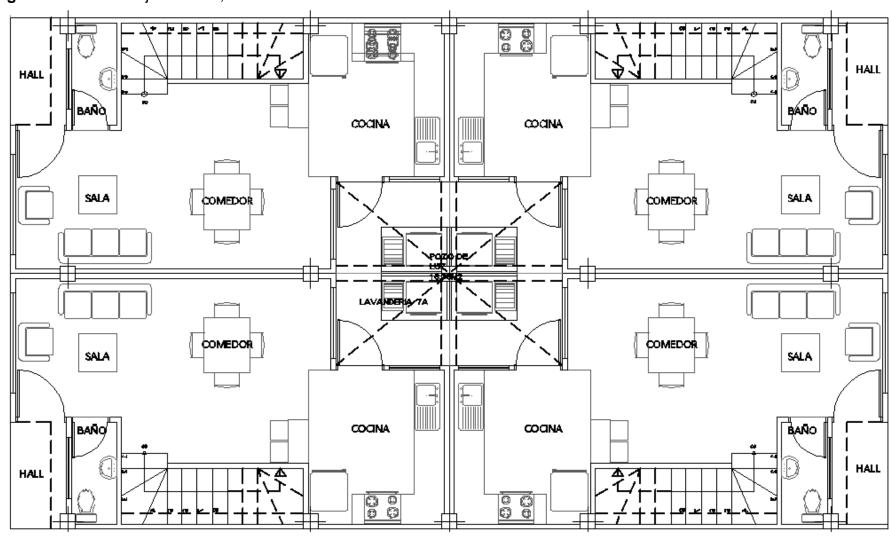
Planta baja N+-0.00, Área = 153.28 m^2
